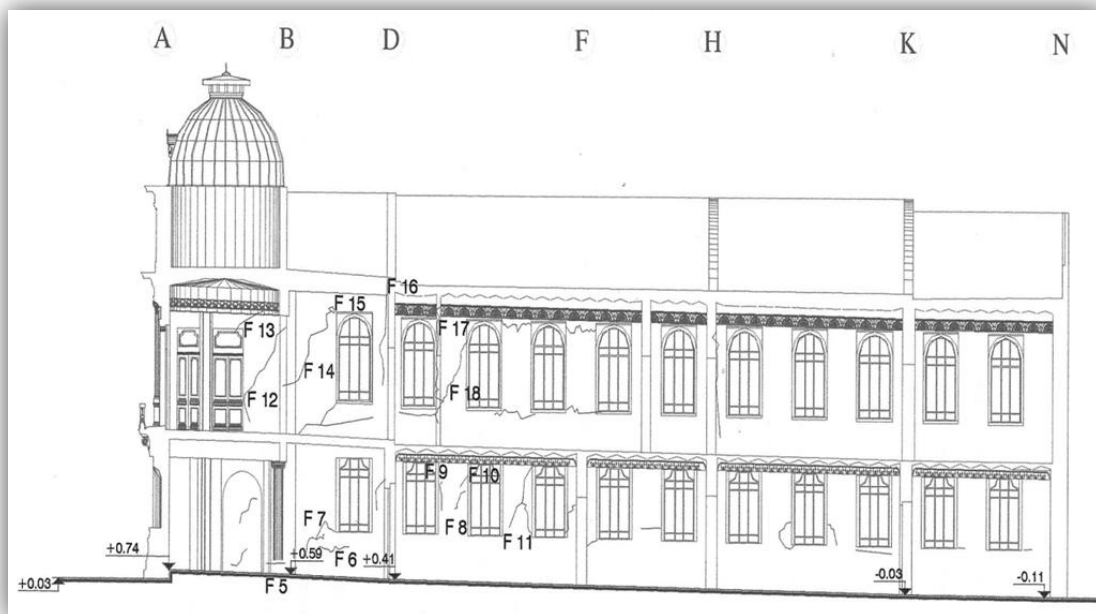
Levantamiento de grietas en la fachada Norte, corte C – C' (2007) [2.17].
